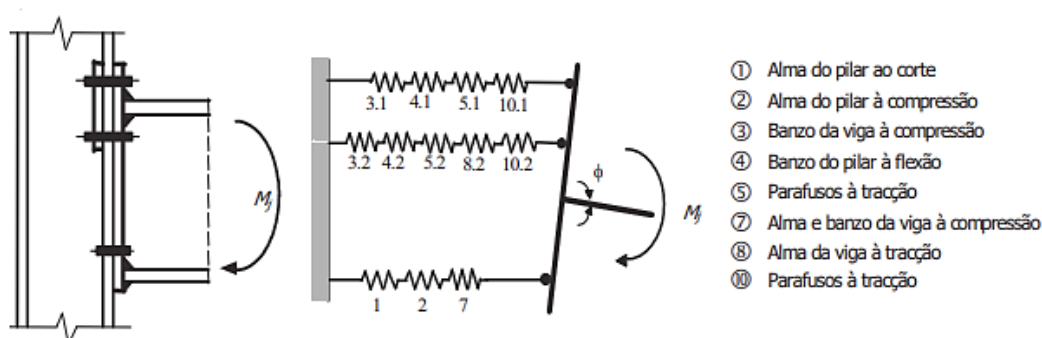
Método das componentes aplicado a uma junta viga-pilar (Simões da Silva & Santiago, 2003)
